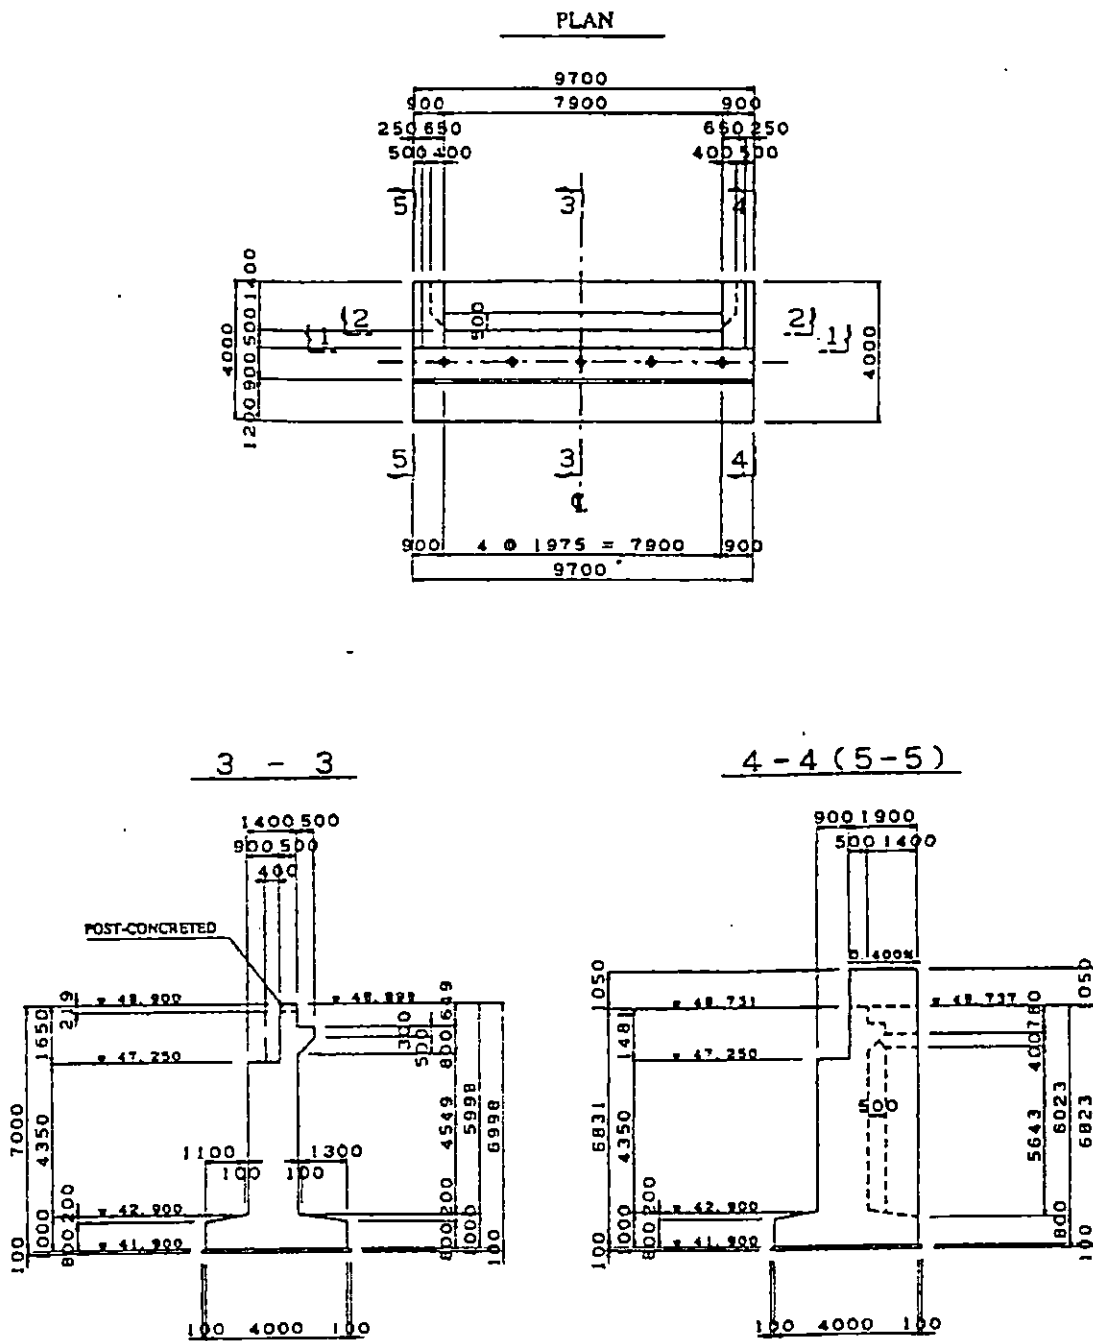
DETALLES DEL ESTRIBO A2.
